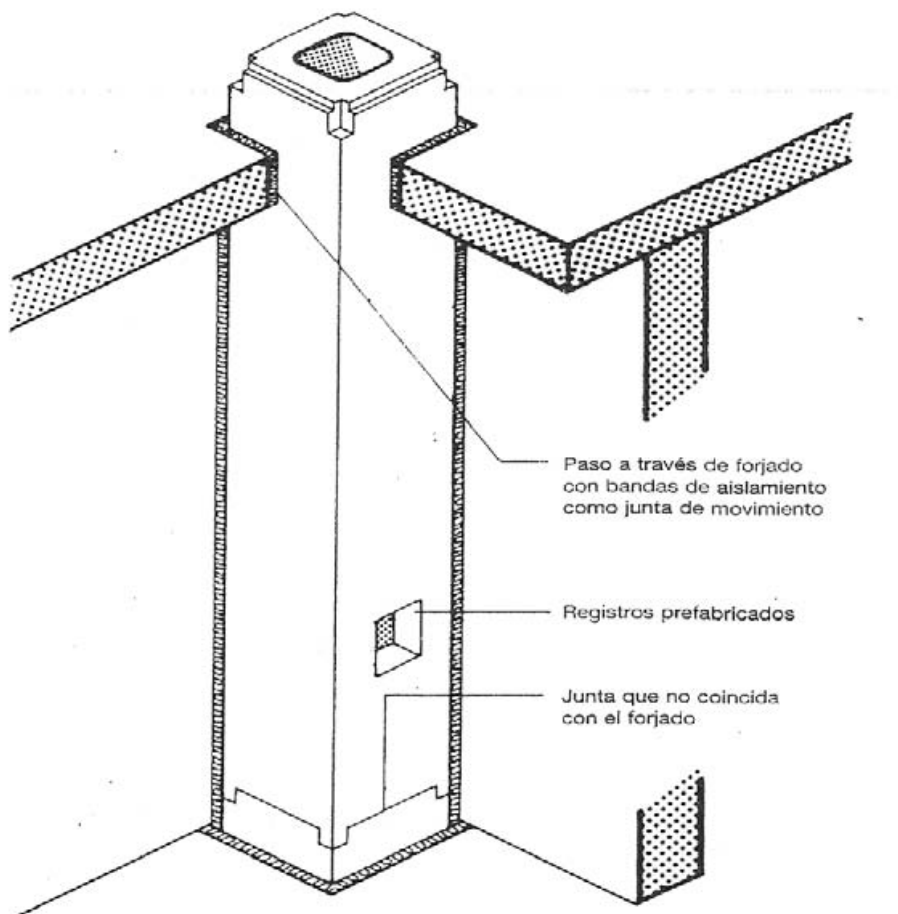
Chimenea de una hoja de una planta de altura. Piezas prefabricadas de hormigón especial
